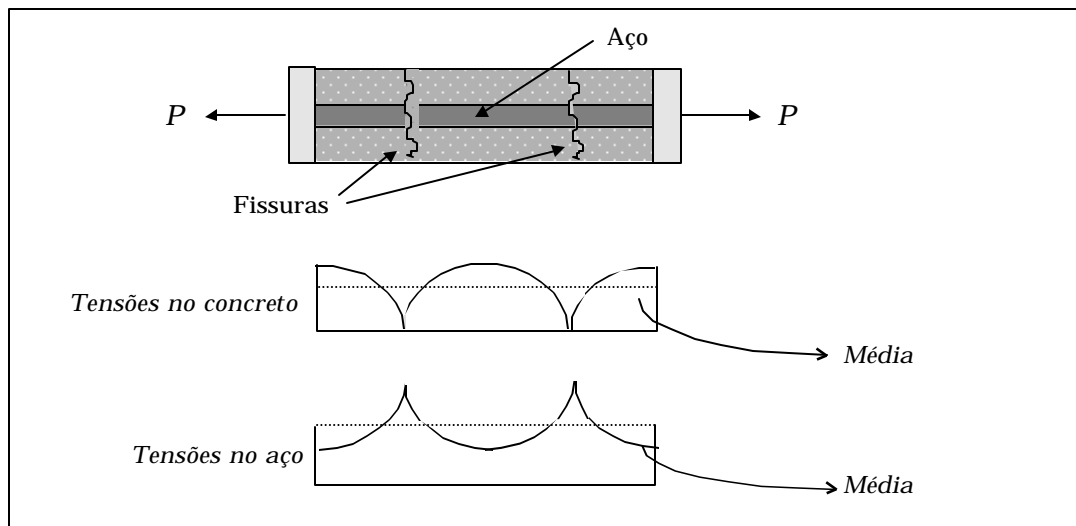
Distribuição de Tensões em um Elemento Fissurado de Concreto Armado.
